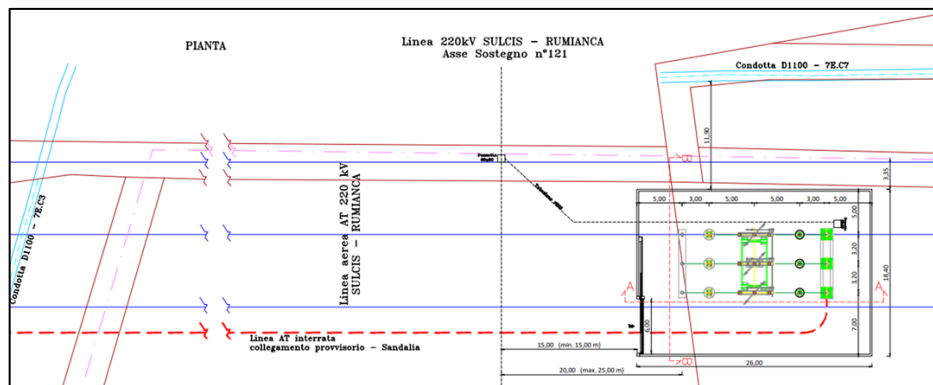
Pianta SE provvisoria (Fonte: ALL7_SE Planimetria Elettromeccanica)
